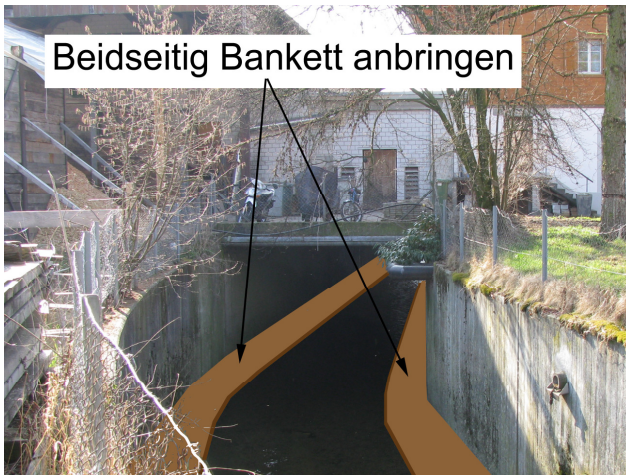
Gewässerdurchlass Rot unter dem Sägereigebäude hindurch (Massnahme GD2)
